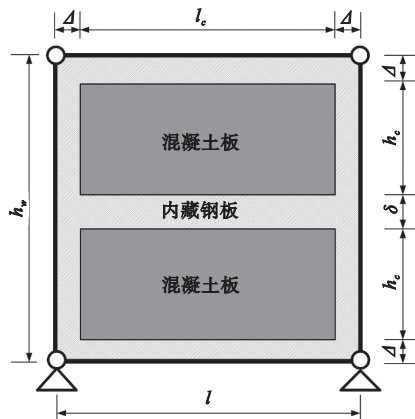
带多块混凝土板的防屈曲钢板剪力墙尺寸构造
